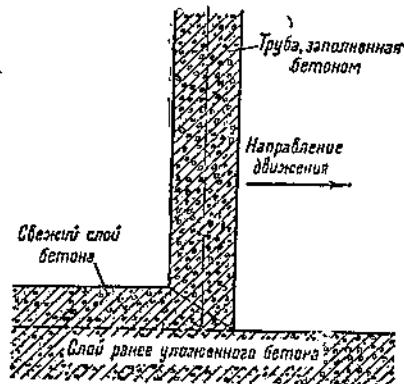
Схема укладки бетона под водой с помощью трубы со склоненным нижним концом.
